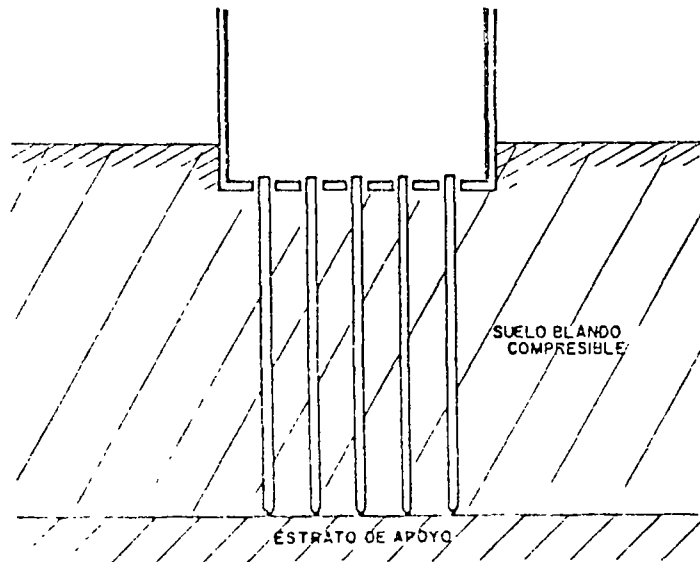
Pilotes de punta atravesando libremente la cimentación
